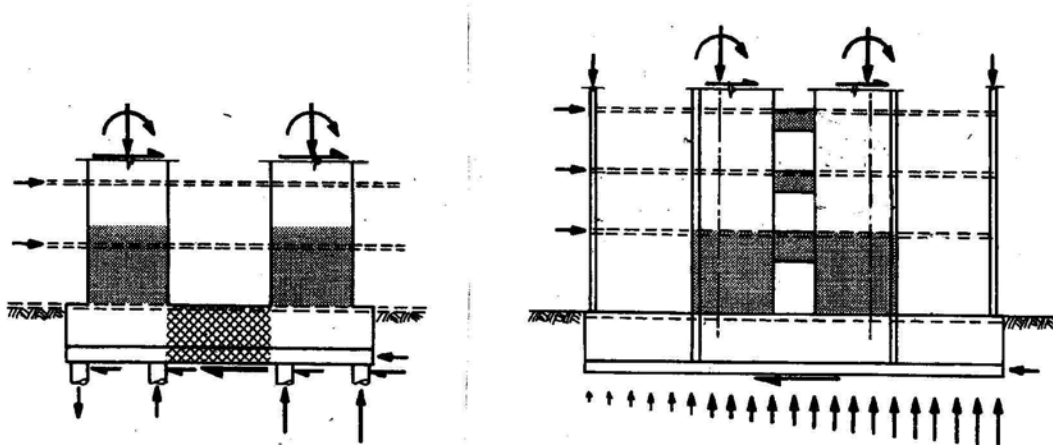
Fondation combinée de 2 voiles de contreventement par des poutres de couplage. A gauche, fondation sur pieu. A droite, fondation directe. [Paulay, 1992.]
